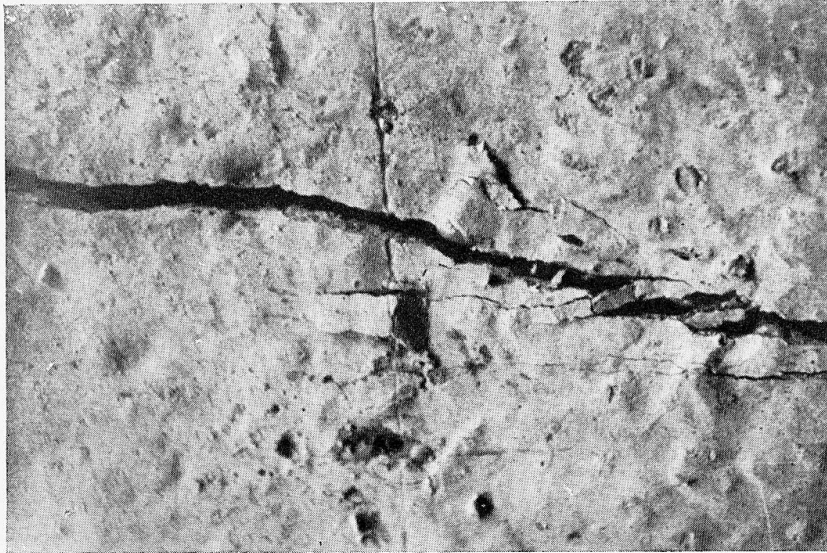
Fissure longitudinale et destruction du béton par compression.
